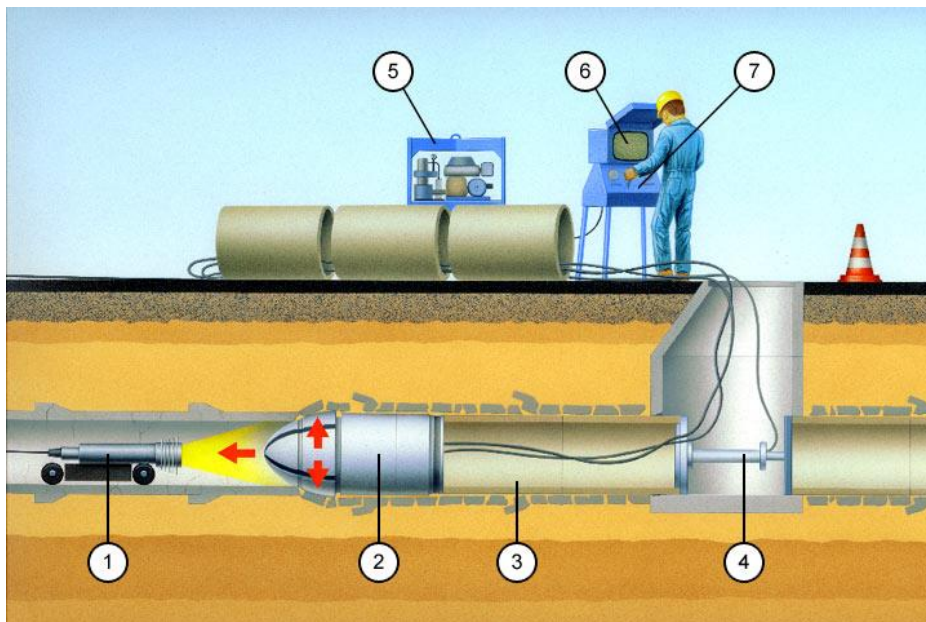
Trhání nefunkčního potrubí zařízením Grundocrack [32]
